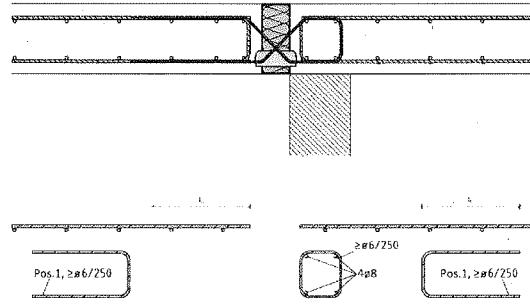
Bewehrungsführung QQ bei direkter Lagerung und deckenseitig geschlauften Querkraftstäben
